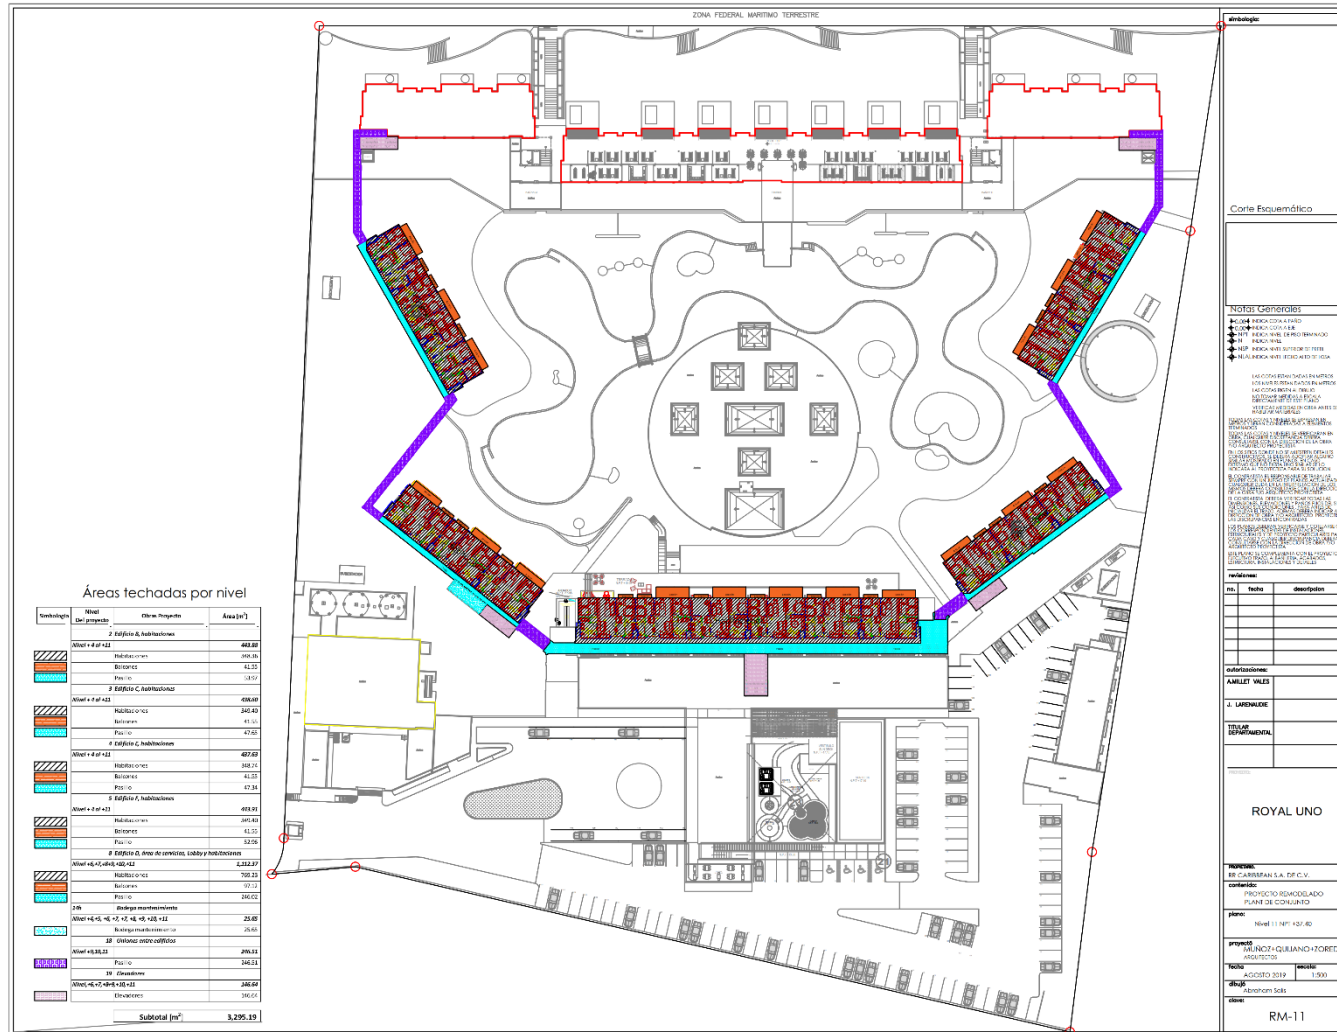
Proyecto remodelado, obras nivel 11. Anexo C-6.
